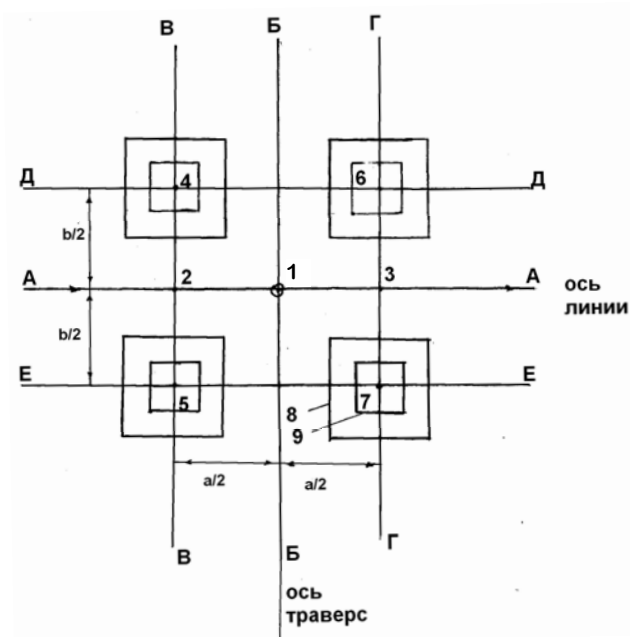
Схема разбивки котлованов для установки подножников под промежуточные металлические опоры:
